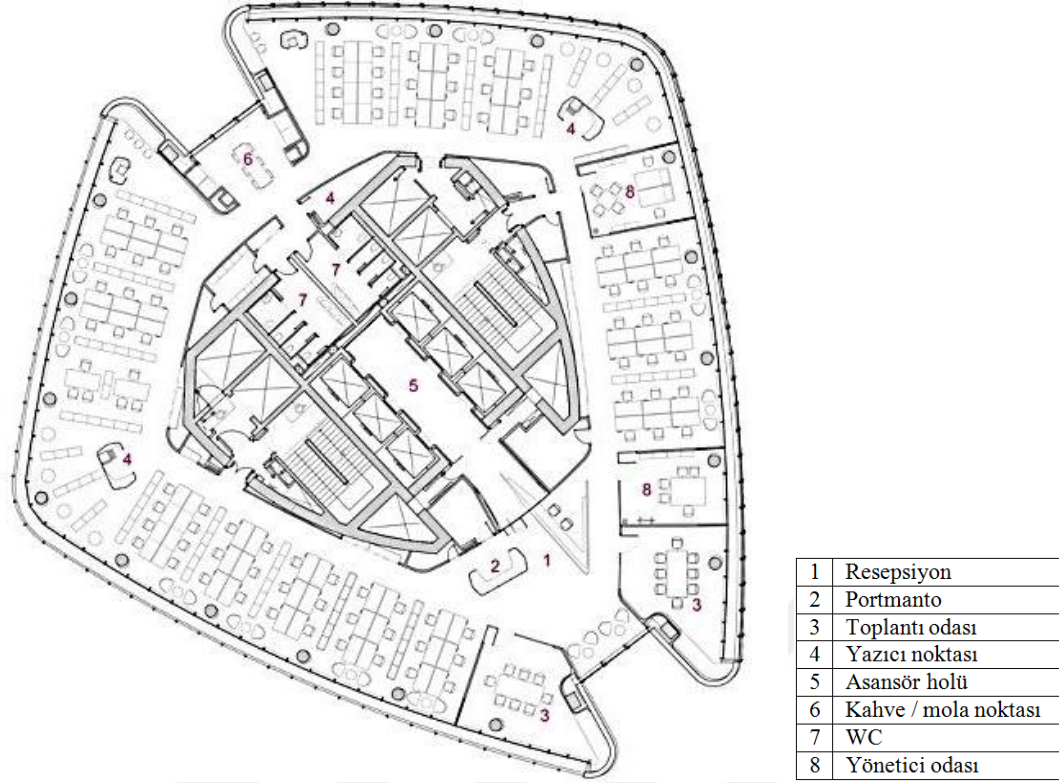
Generali Tower alt zemin kat planı (Archdaily, 2019a)
